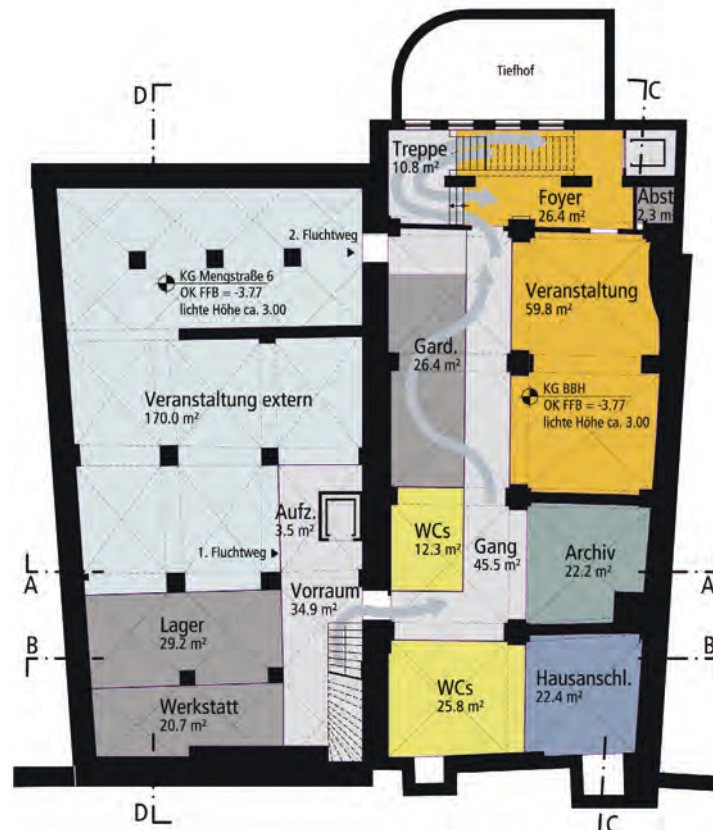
Variante 1, Grundriss Keller
